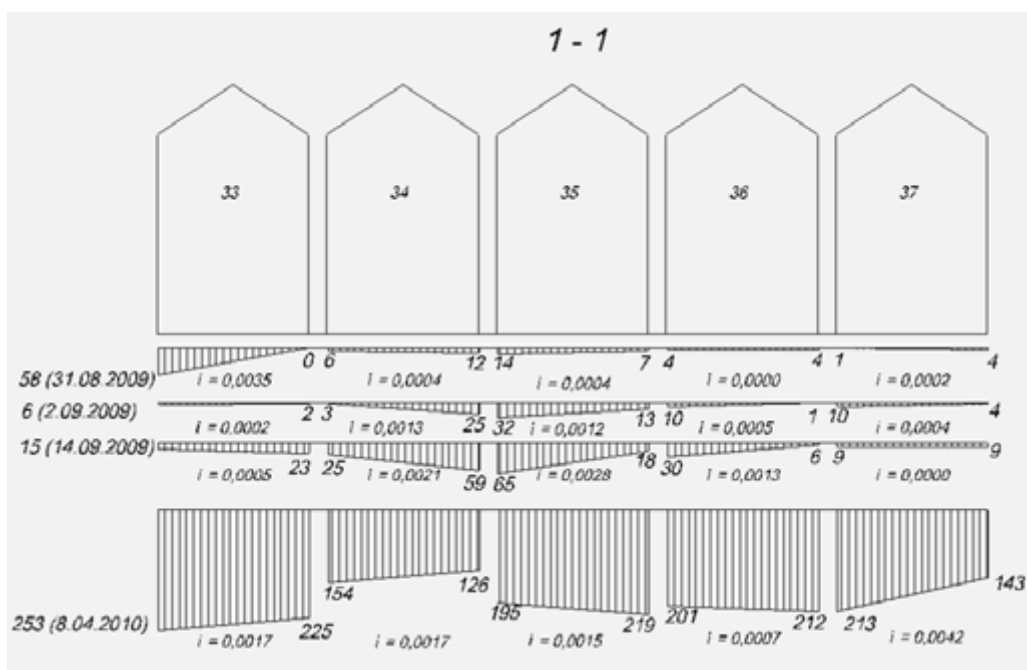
Эпюры осадок ряда зернохранилищ СМВУ 165.18.В12 №33 – №37 в продольном направлении, мм; i – крен фундамента вдоль ряда
